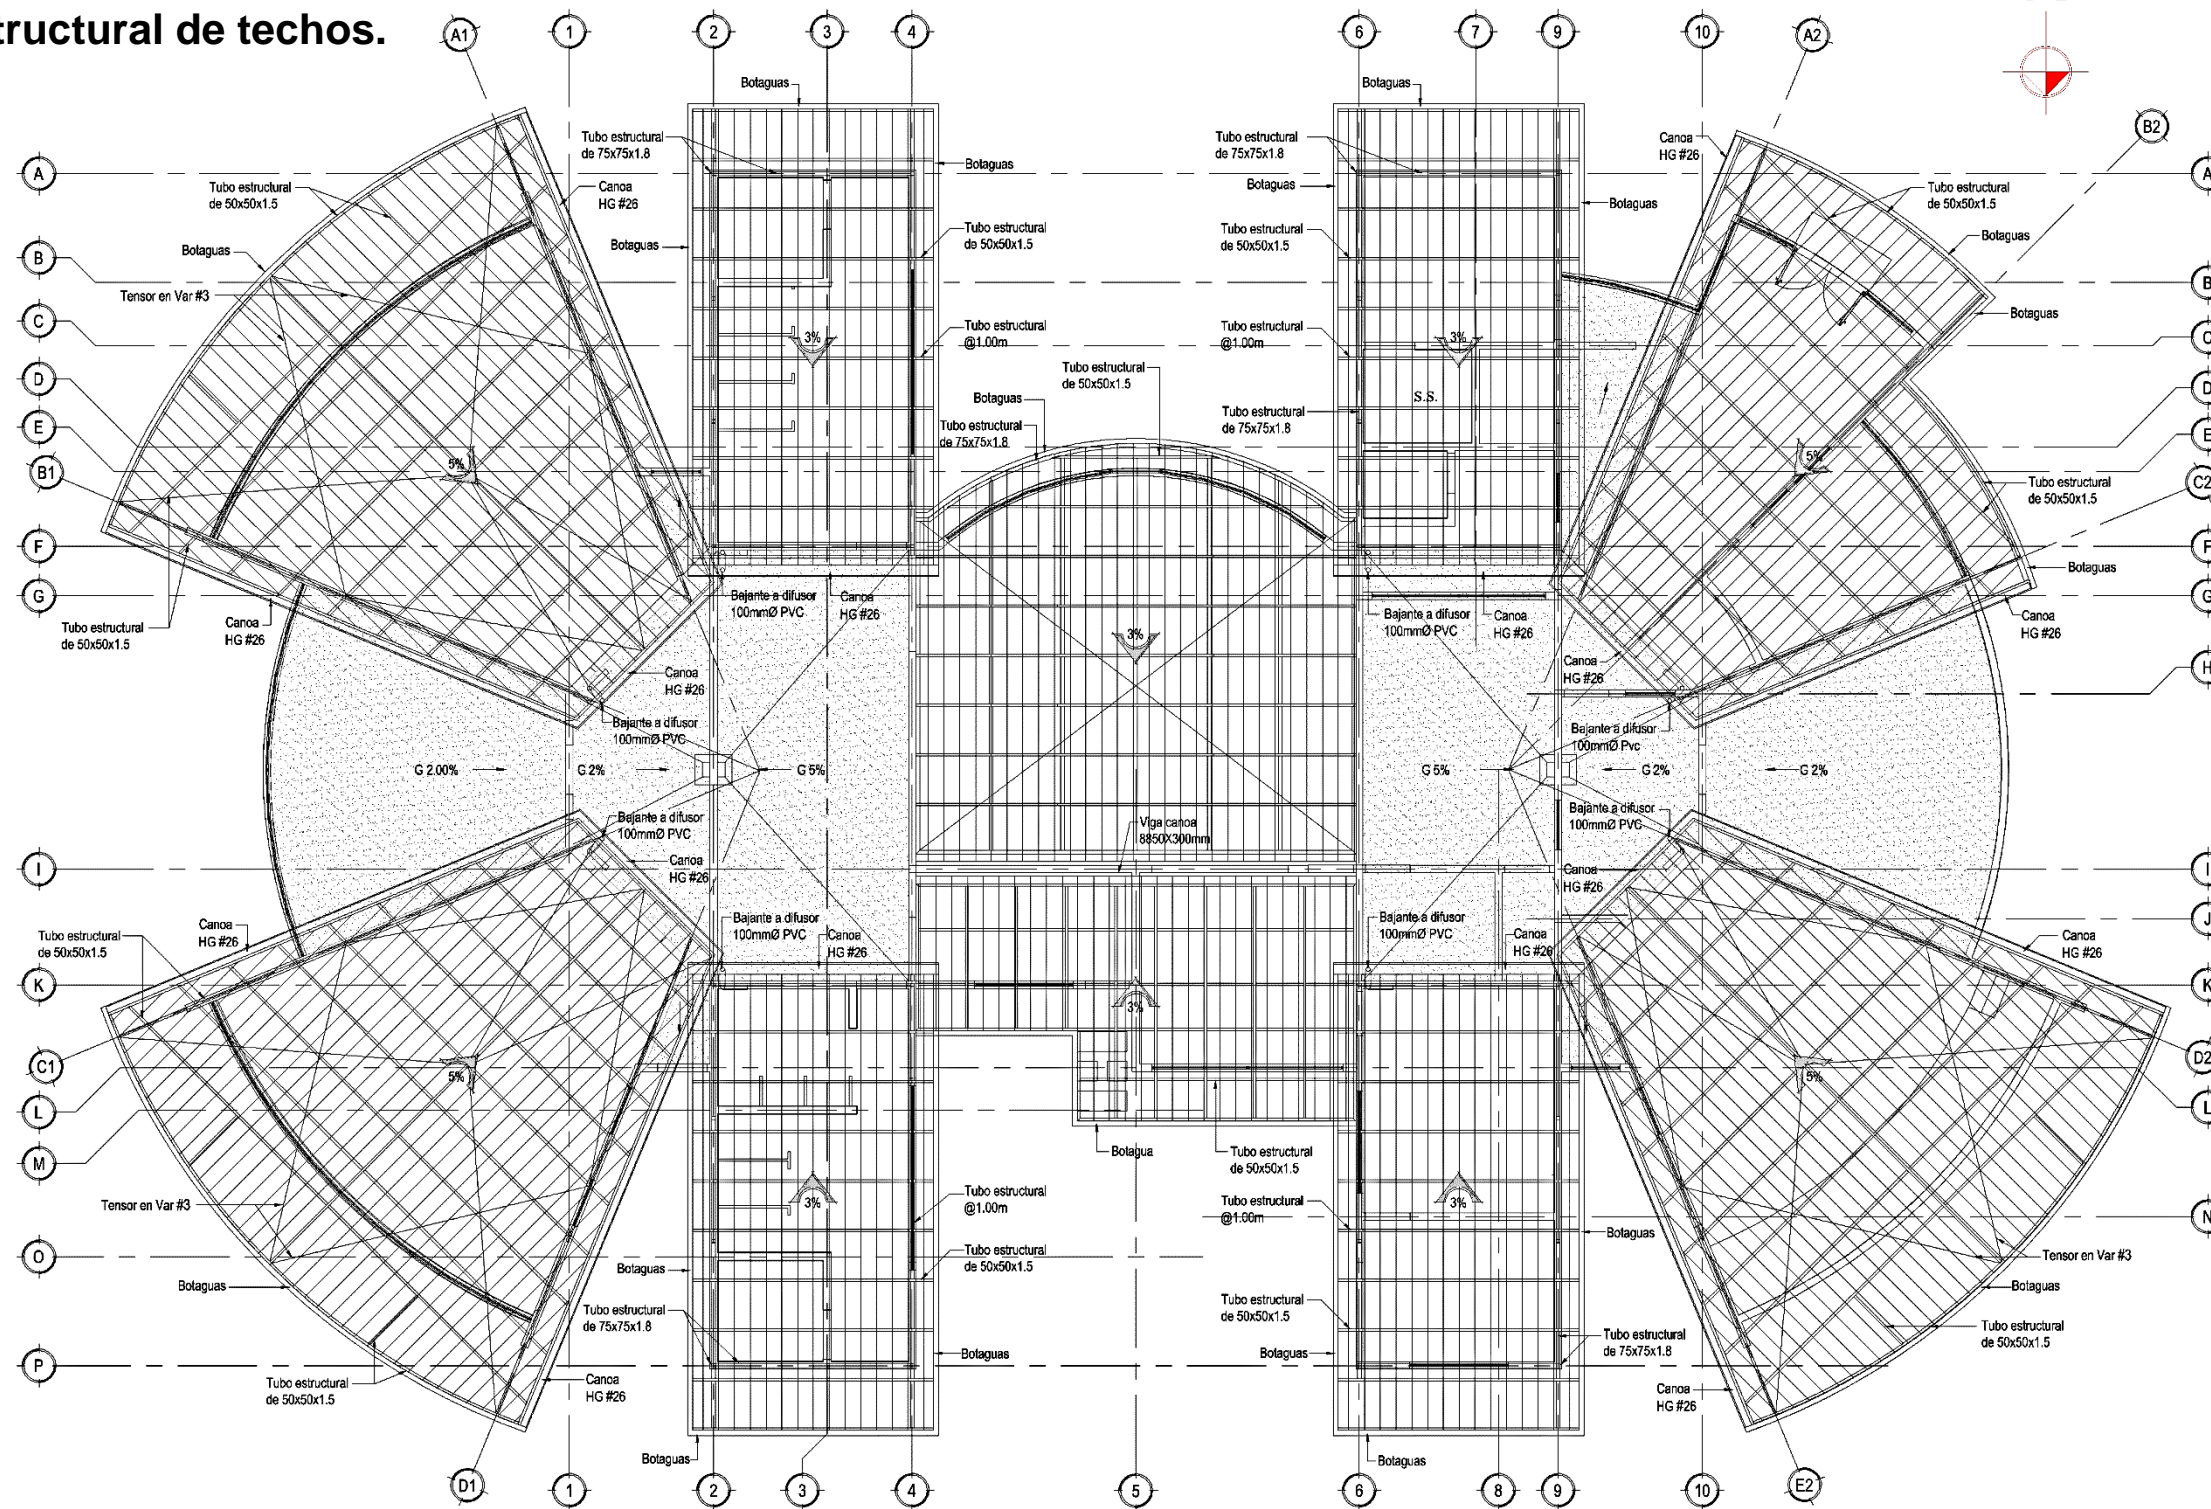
Planta estructural de techos. Fuente: elaboración propia.
